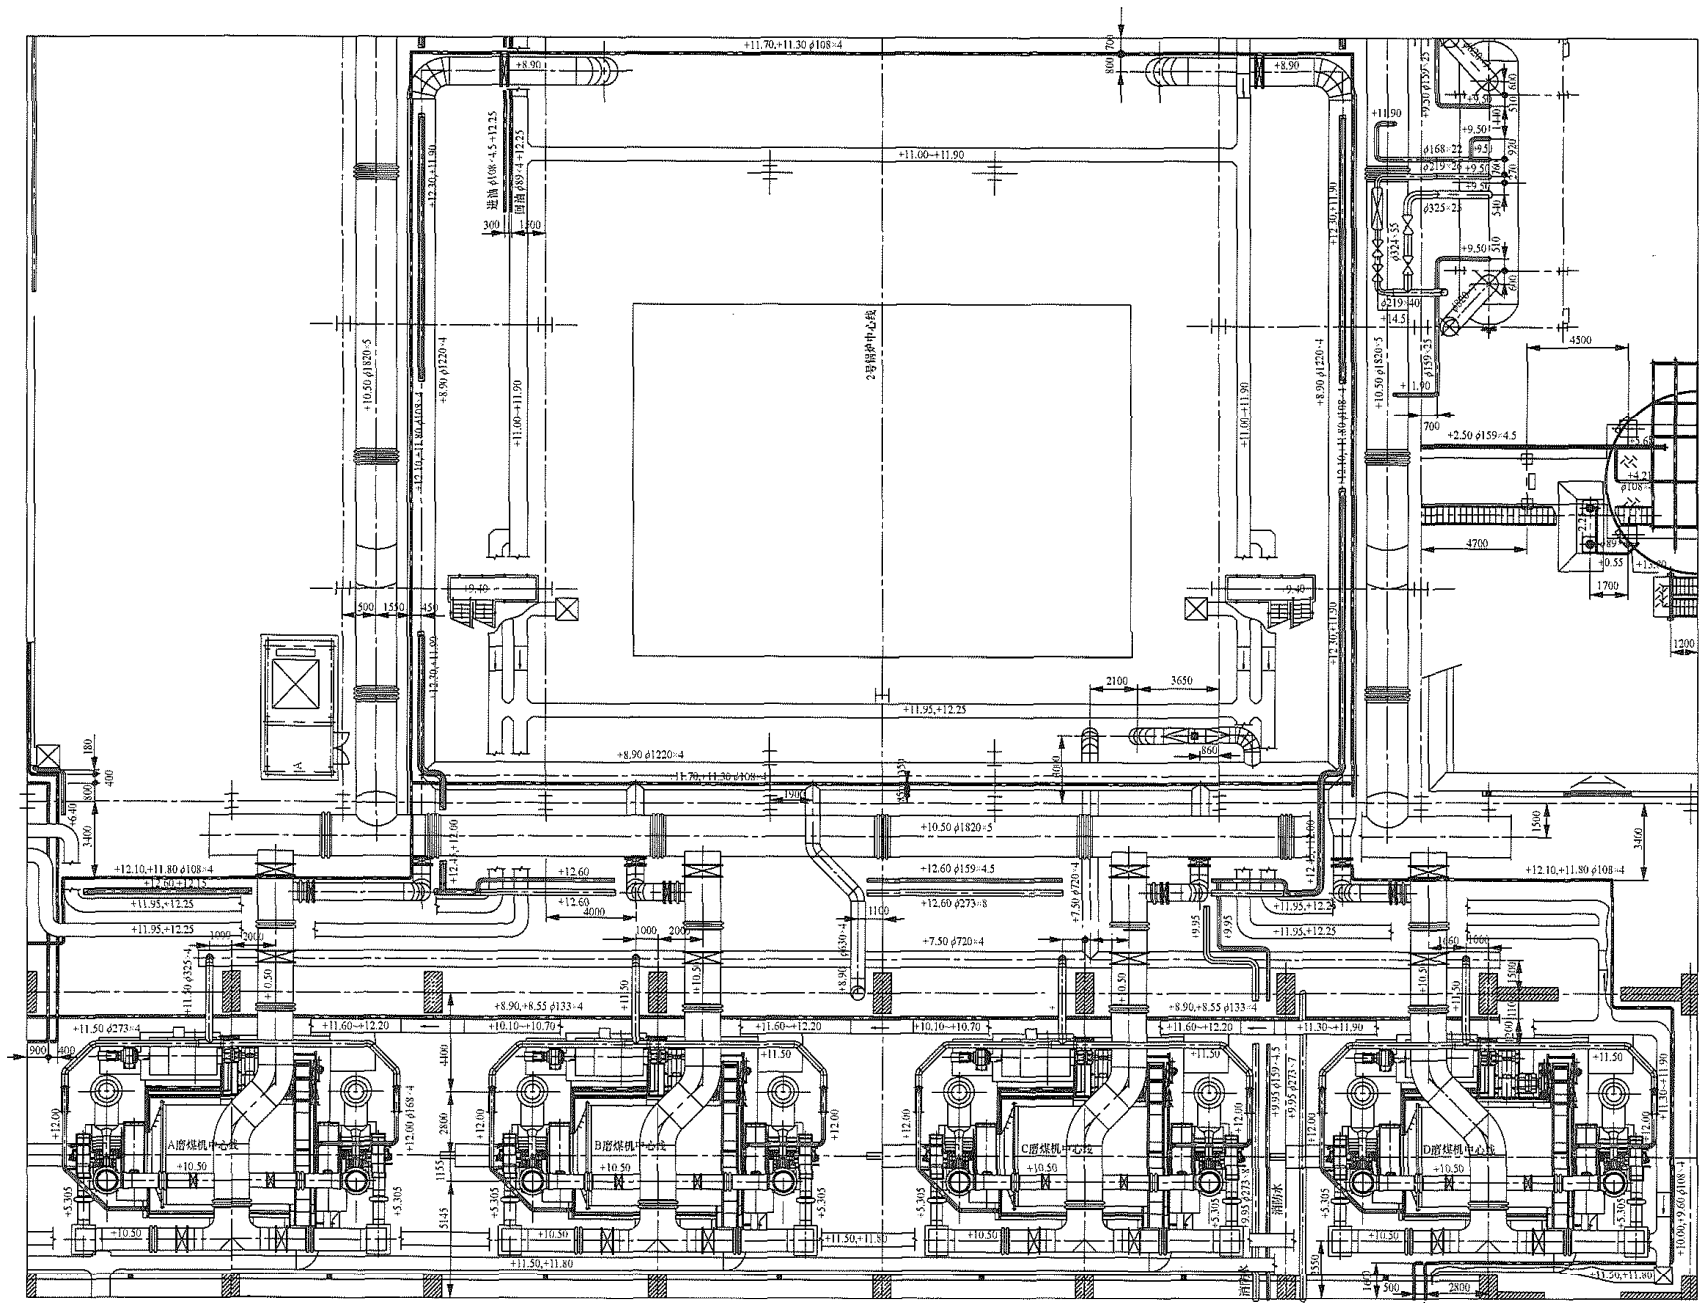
双进双出磨煤机前煤仓和锅炉房平面布置示意图 (一)
